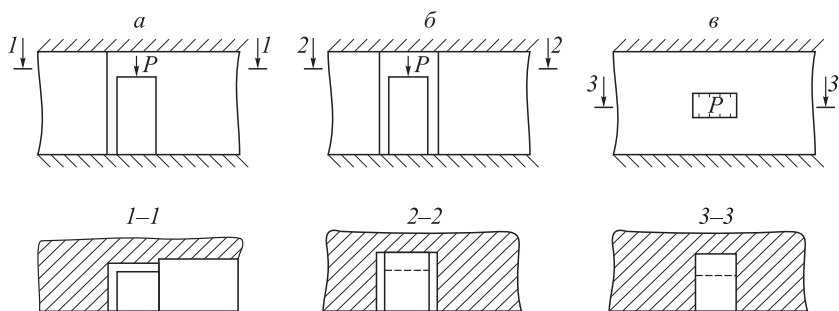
Схемы натуральных испытаний на сжатие.
